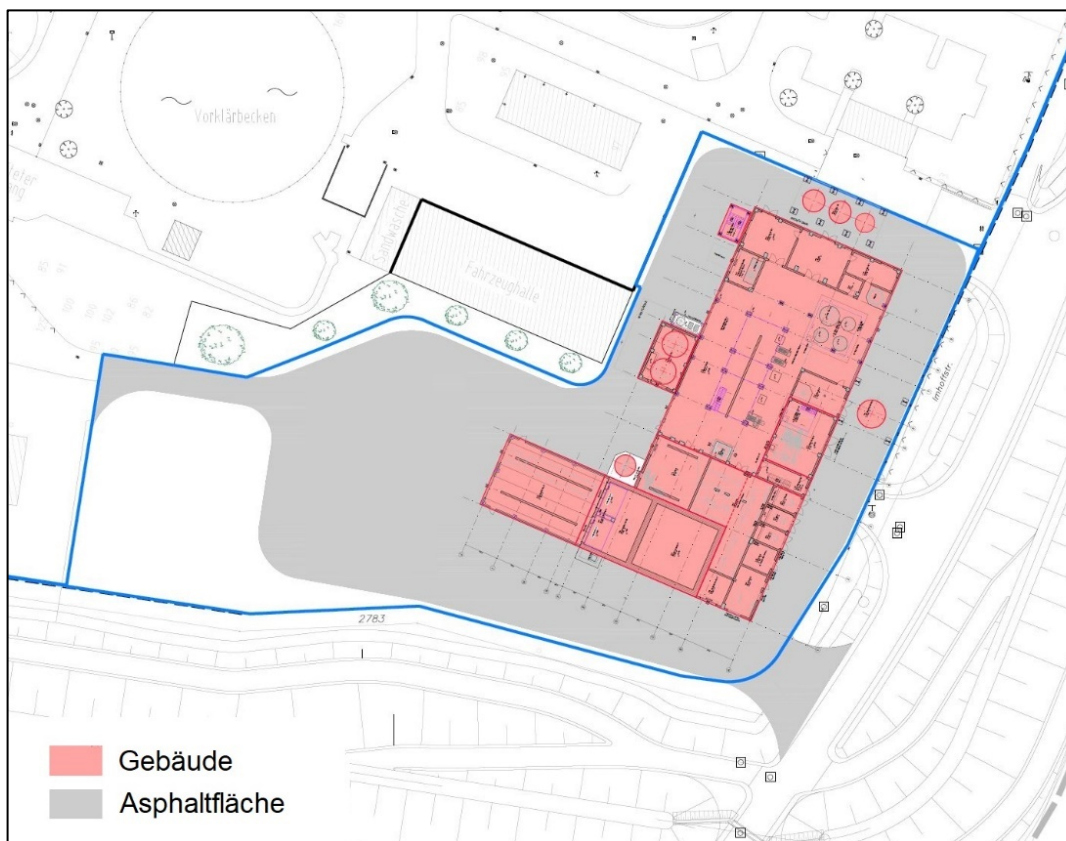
Lageplan mit zu bebauenden und versiegelten Flächen
